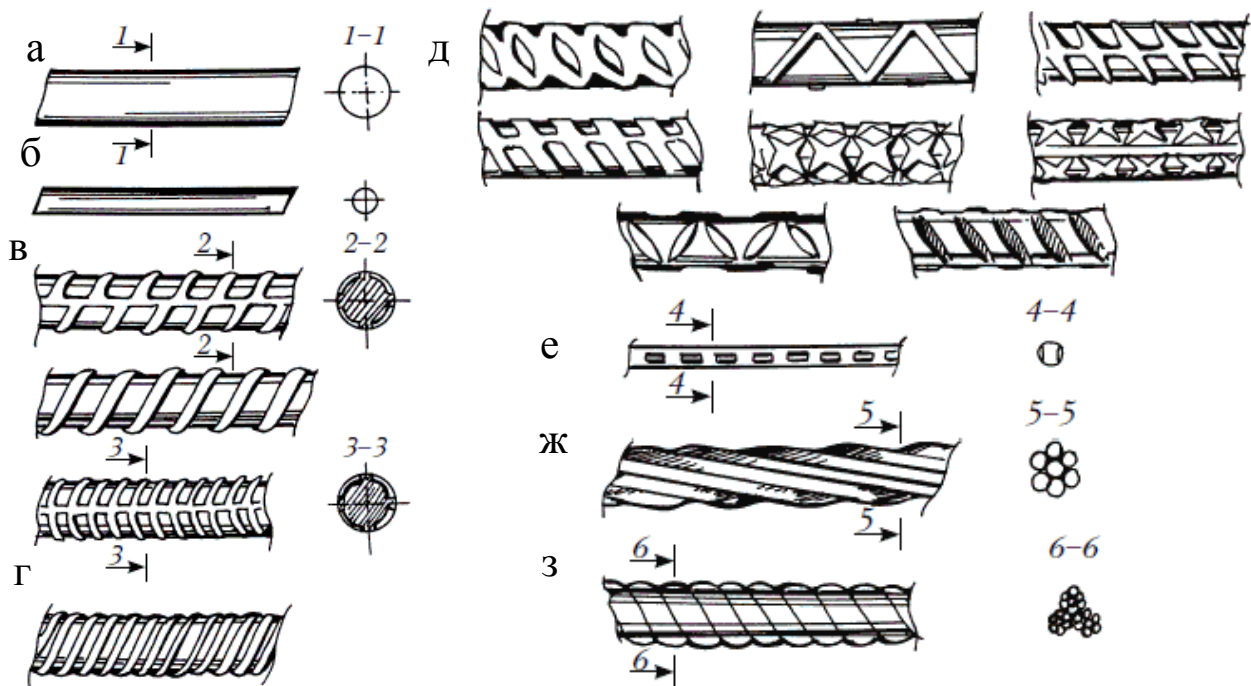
Арматура за типами й різновидами поперечного перерізу: а – гладкий гарячекатаний стрижень (тип арматури А-I); б – дротова арматура круглого перетину; в – стрижнева гарячекатана арматура періодичного профілю (тип арматури А-II); г – стрижнева гарячекатана арматура періодичного профілю (типи арматури А-III і А-IV); д – стрижнева гарячекатана арматура періодичного профілю менш поширених типів; е – холодносплющена дротова арматура періодичного профілю; ж – семидротове пасмо класу К-7; з – трипасмовий трос класу К-3
